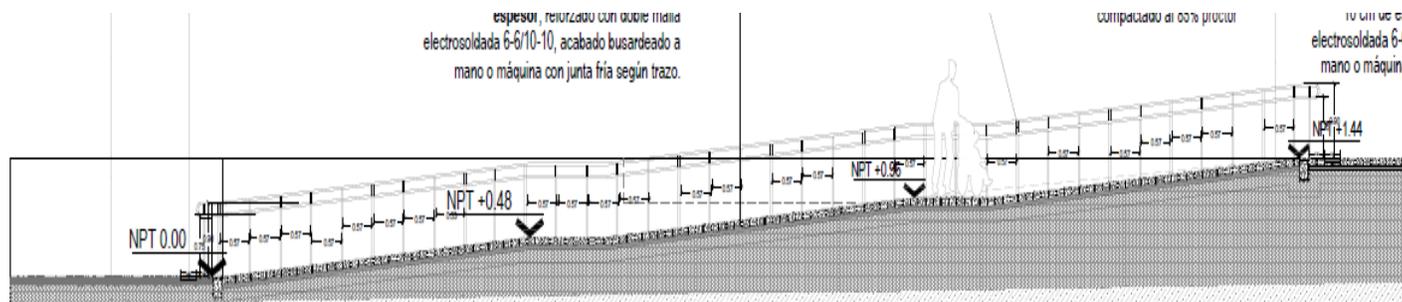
Plano de perfil de las protecciones en el barandal de rampas de acceso. (Archivo Personal)
